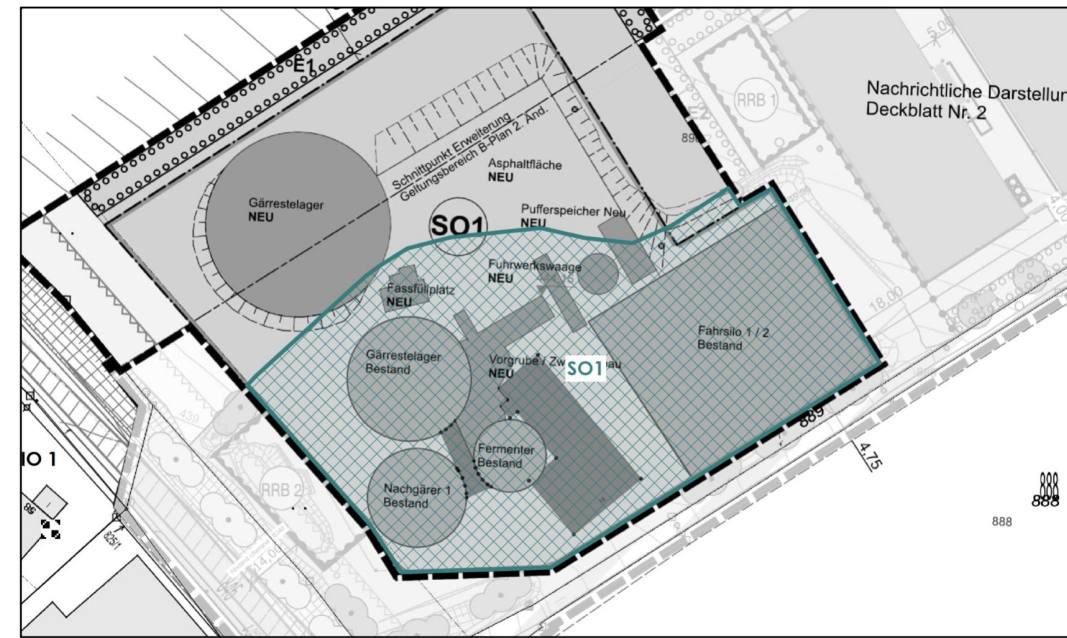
Lageplan mit Darstellung der Emissionsbezugsfläche.
